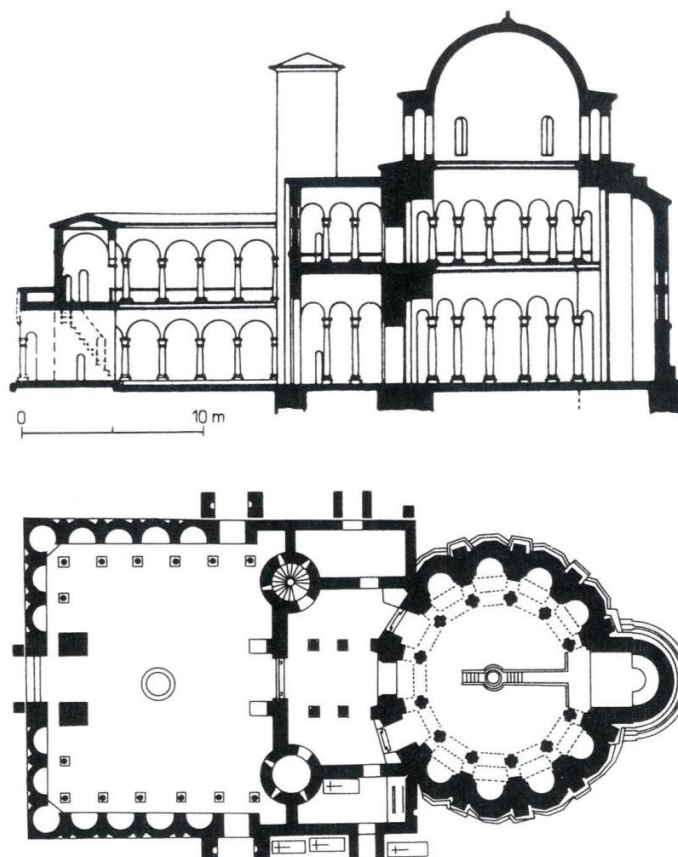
Rawenna – przekrój podłużny i plan kościoła San Vitale, za J. Pijoan
